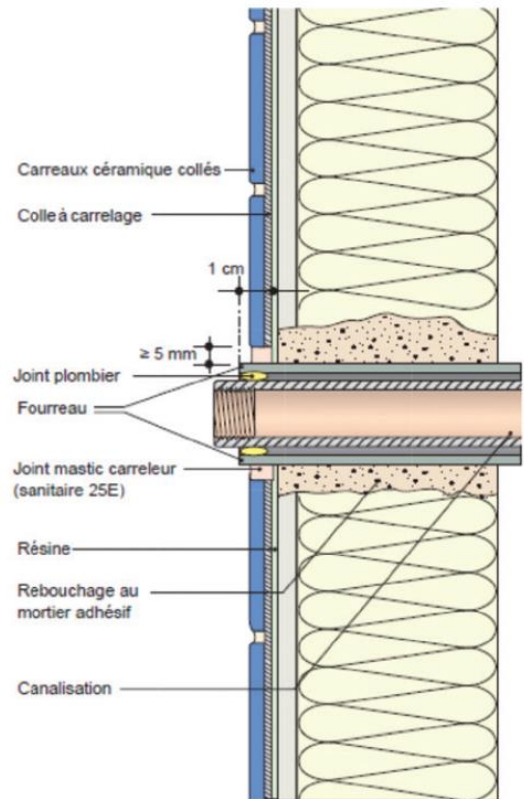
Traitement d'une canalisation traversante avec fourreau en paroi verticale ; exemple d'une cloison en plaque de parement en plâtre.
